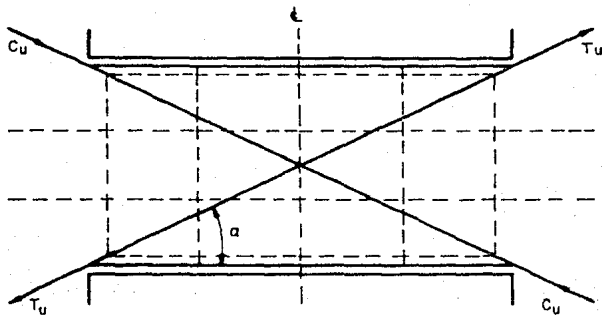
a) Modelo de viga de acoplamiento reforzada diagonalmente.
